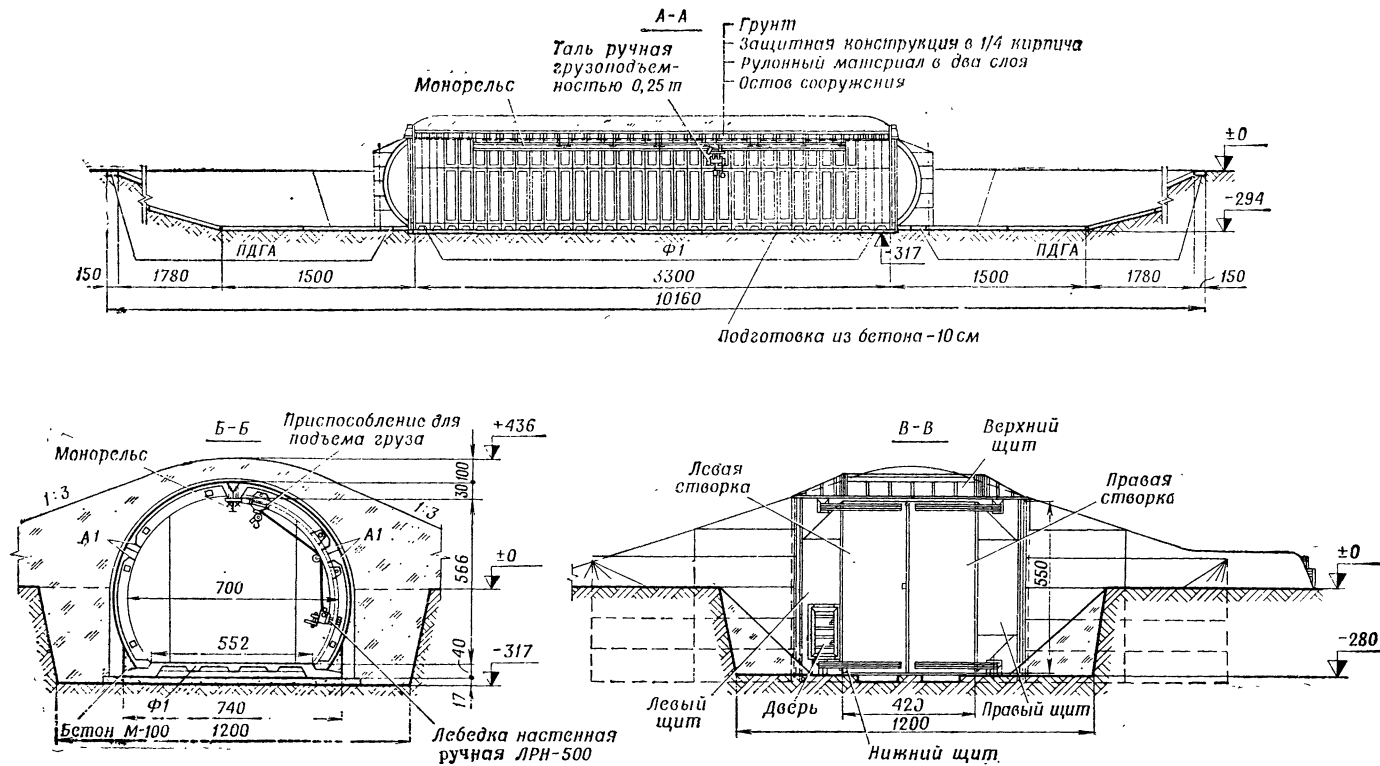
Сборное железобетонное сооружение «Гранит-2» (разрезы)
